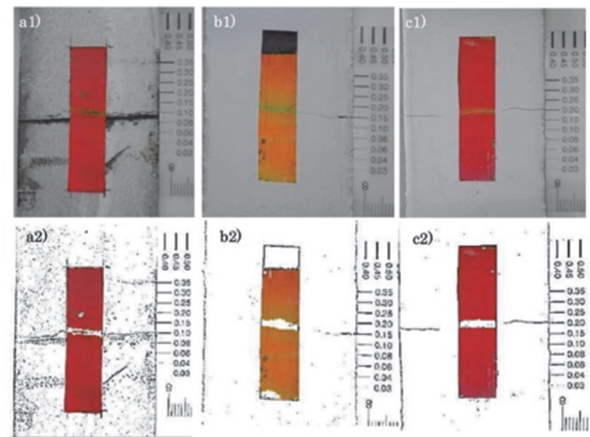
スマホアプリによる変状判定例。上段が元画像下段がクロマキー合成により健全部以外を透明化(a)ひび割れ注入部への施工(b)(c)表面被覆への施工
